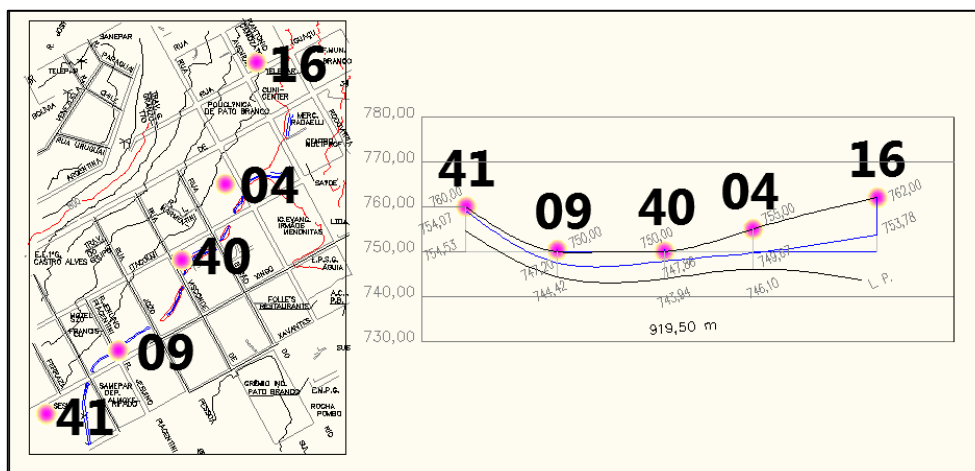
Perfil do subsolo para as sondagens: 41, 09, 40, 04 e 16.
